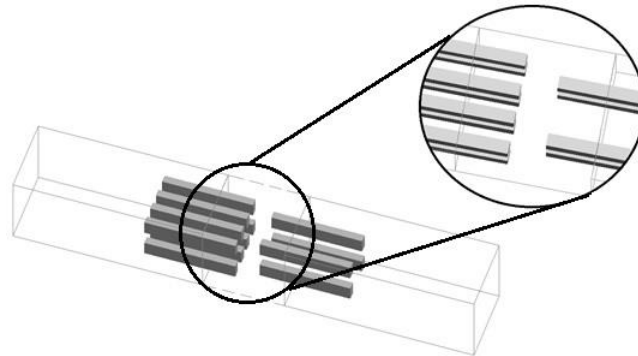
Ligação Viga-Viga por chapas metálicas aparafusadas com betonagem *in situ
